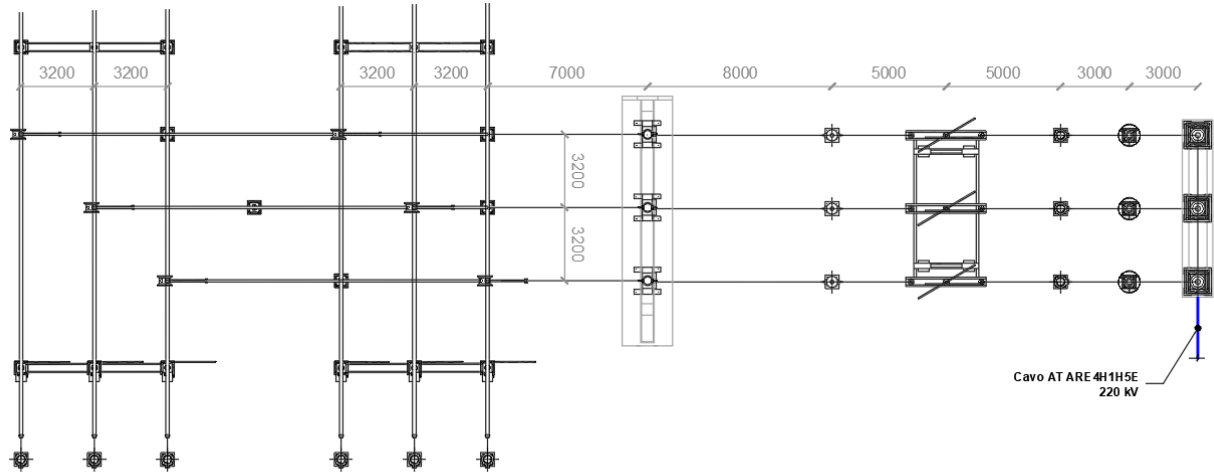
Planimetria elettromeccanica tipologica stallo di consegna TERNA
